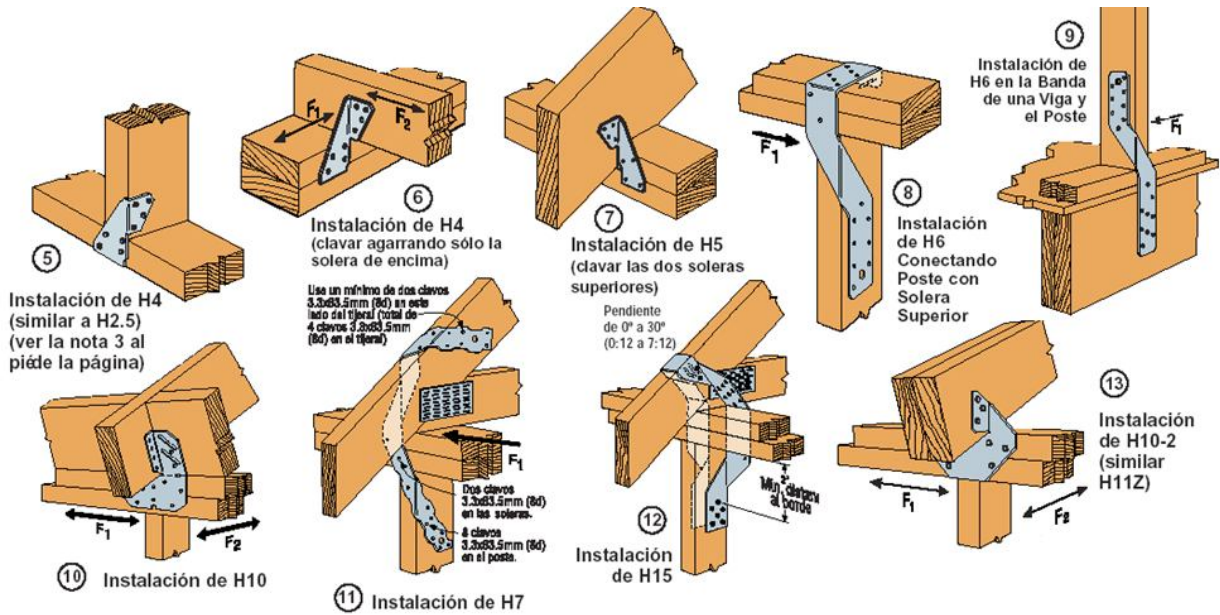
Detalles de Conectores tipo “H” haciéndole un dobles para otro tipo de instalación.
